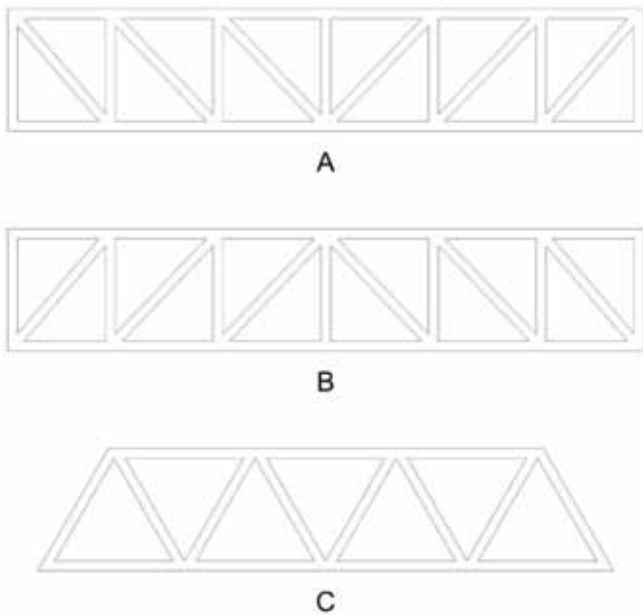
Alguns tipos de treliças planas para Light Steel Framing.
